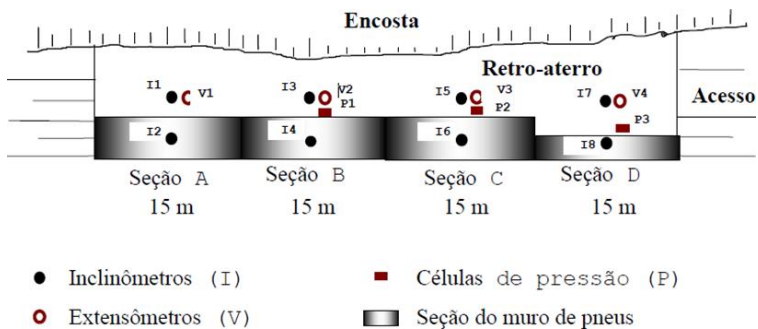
Planta esquemática do muro experimental e da instrumentação de campo (Medeiros et al., 2000).
